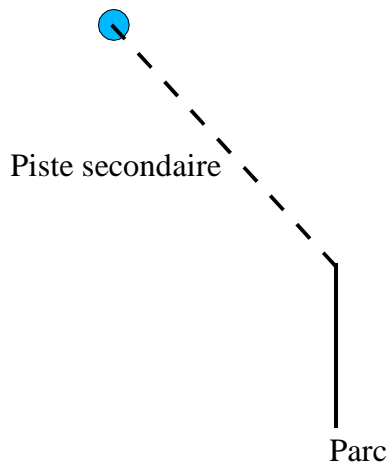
Tracé d'une piste secondaire en bout de piste principale
